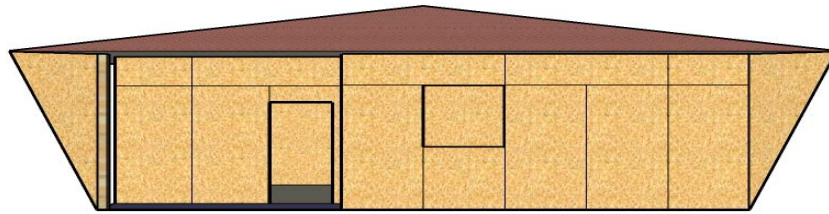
Levantamento de uma parede com fixação prévia das placas de OSB.
